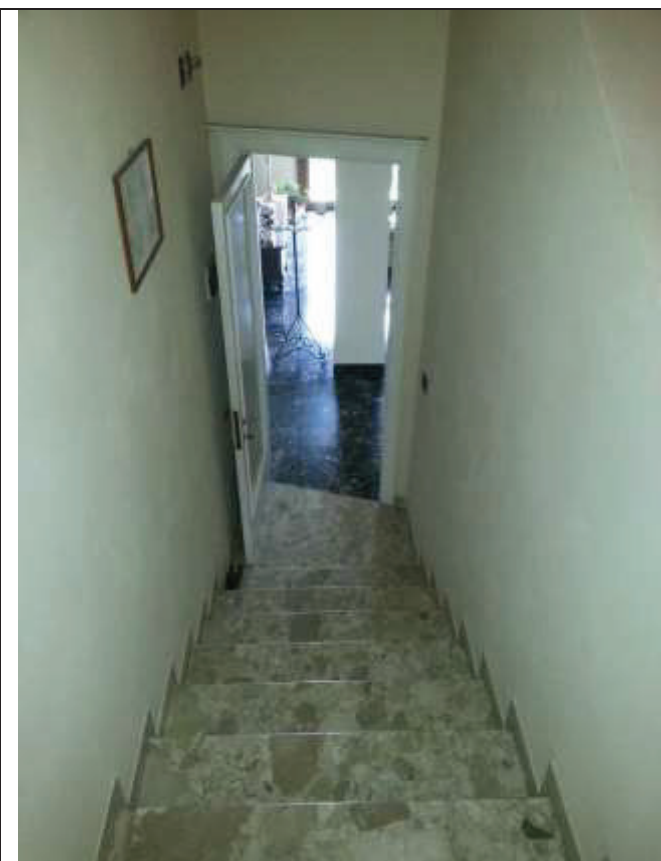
Porta d'accesso e vano scala interno che collega con il piano terzo (soffitta). Pianerottolo della soffitta. In ROSSO la scala metallica che collega con la torretta in copertura.
